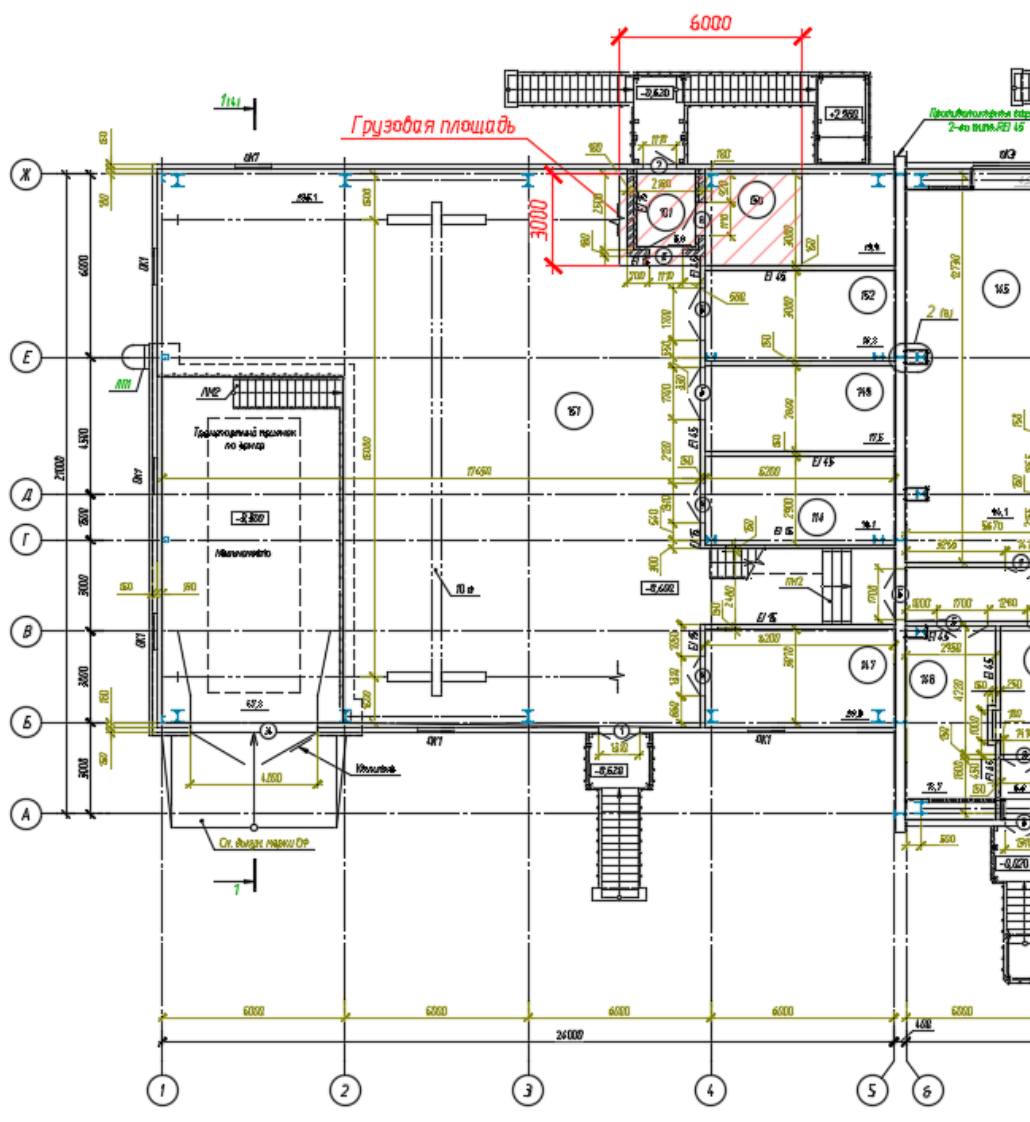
Грузовая площадь колонны на отметке минус 0,6 м
